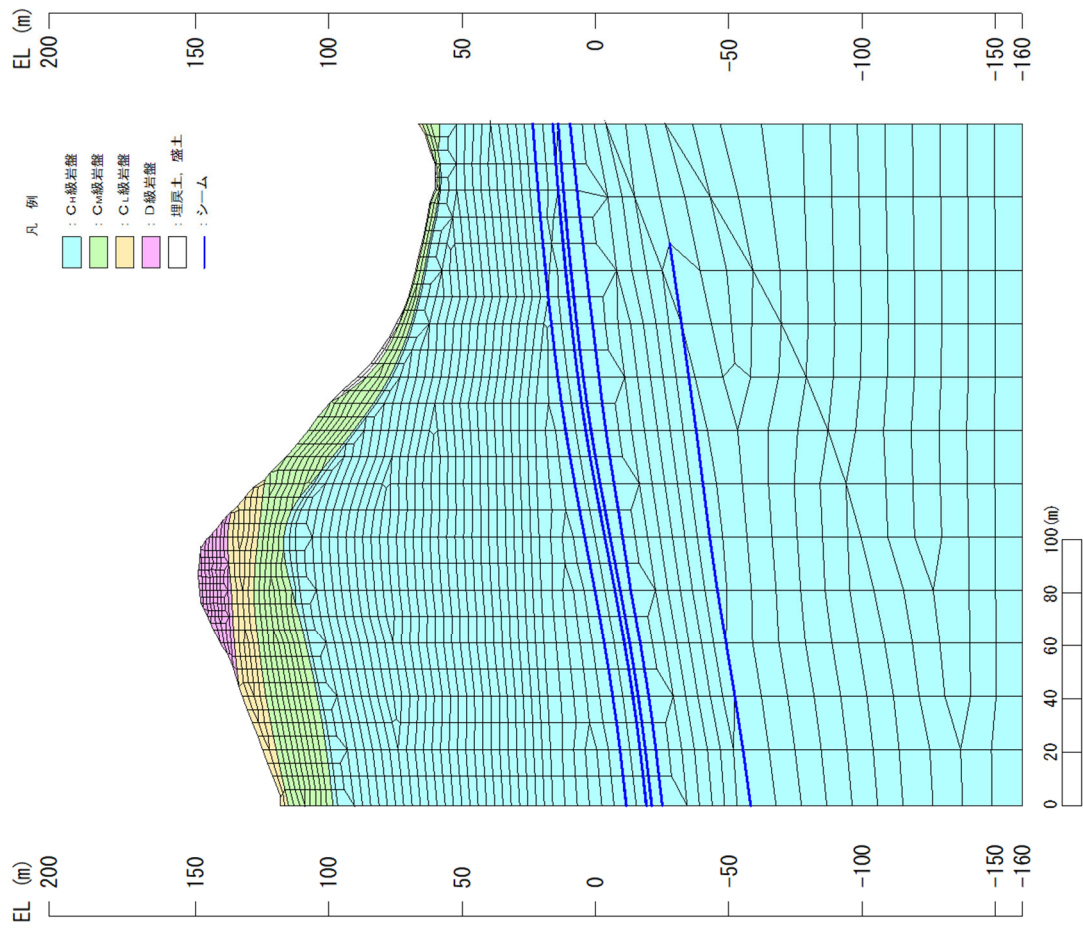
解析モデル図 (B-B' 断面)
